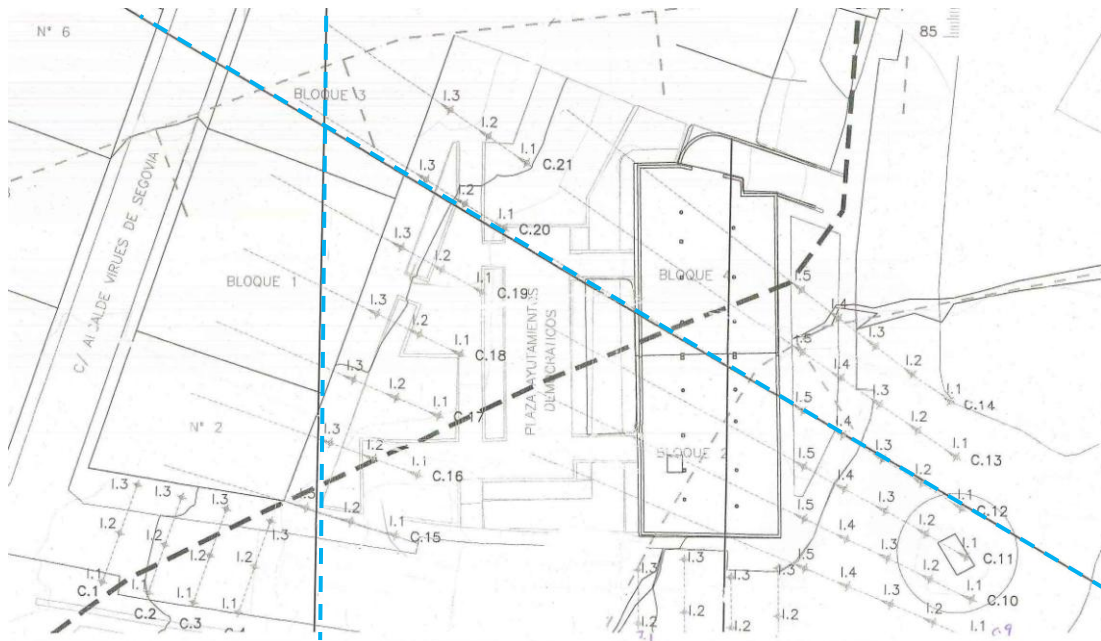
Planta de distribución de contrafuertes de inyecciones armadas y drenes subhorizontales (trazos discontinuos en azul) (Yanes, 2.011)
